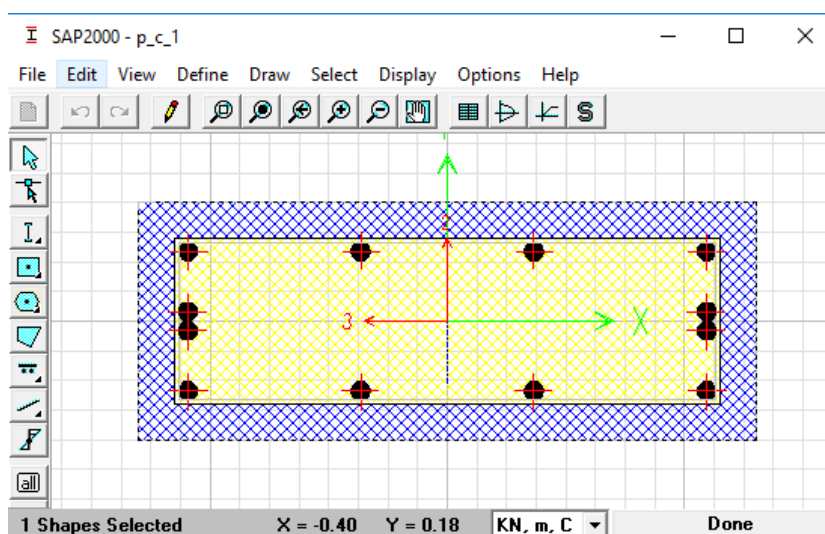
Secção do pilar P1.1.i na ferramenta *Section Designer
